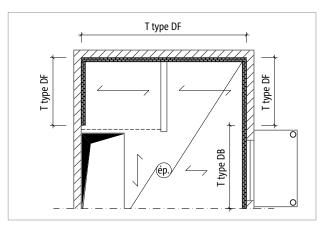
Schöck Rutherma® T type DF : utilisation entre la dalle et la façade
